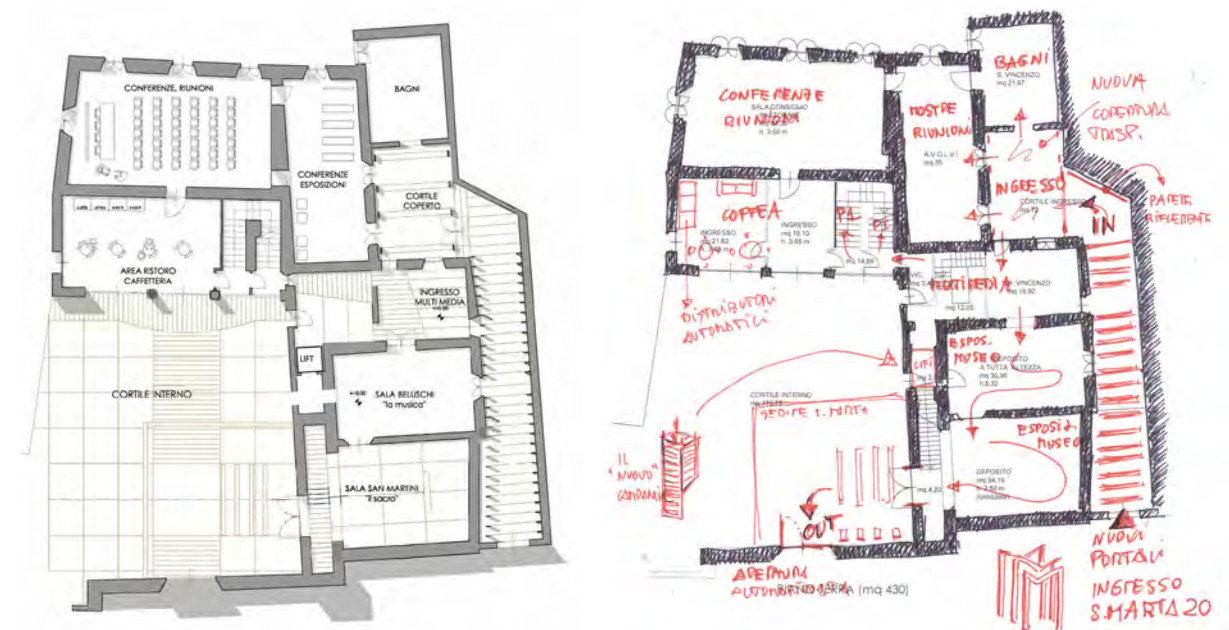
A sinistra, la nuova distribuzione funzionale. La presenza di pavimenti in battuto di cemento ed in piastrelle in gres nella maggior parte dei vani interessati dall'intervento, ha facilitato la realizzazione dei vespai areati, la distribuzione impiantistica, la progettazione dedicata dei nuovi pavimenti esterni ed interni. A destra, lo studio dei percorsi, delle nuove funzioni, dei nuovi segni dedicati alla memoria di Santa Marta, alla valorizzazione del nuovo ingresso costretto in un vicolo lungo e stretto.
